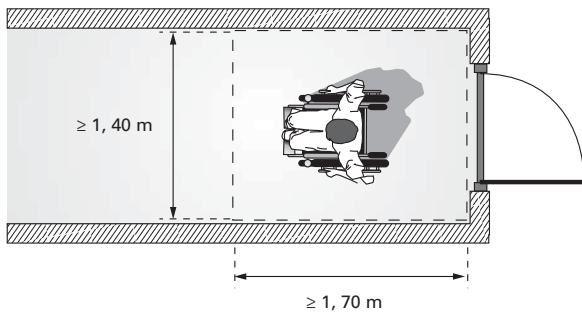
La largeur des circulations horizontales des ERP étant de 1,40 m, l'espace de manœuvre de porte « poussant » doit être au minimum de 1,70 x 1,40 m
